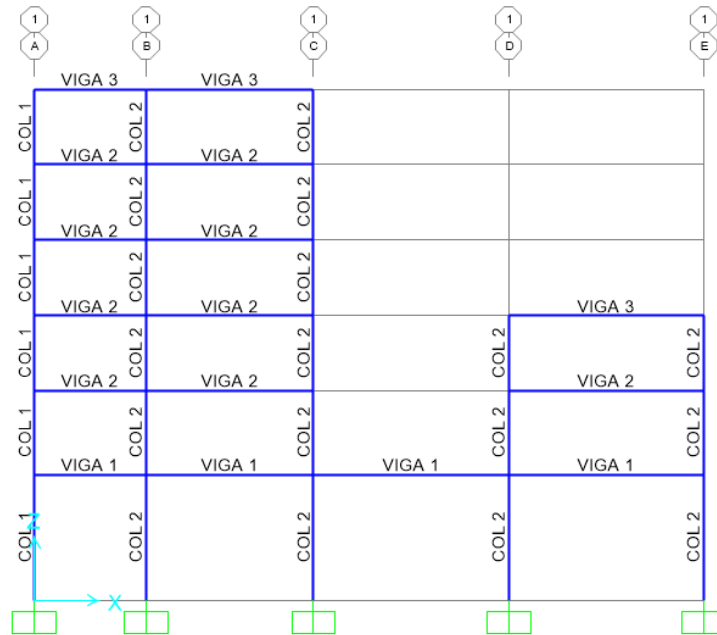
Vista en SAP2000 del Pórtico 3. Plano X-Z
